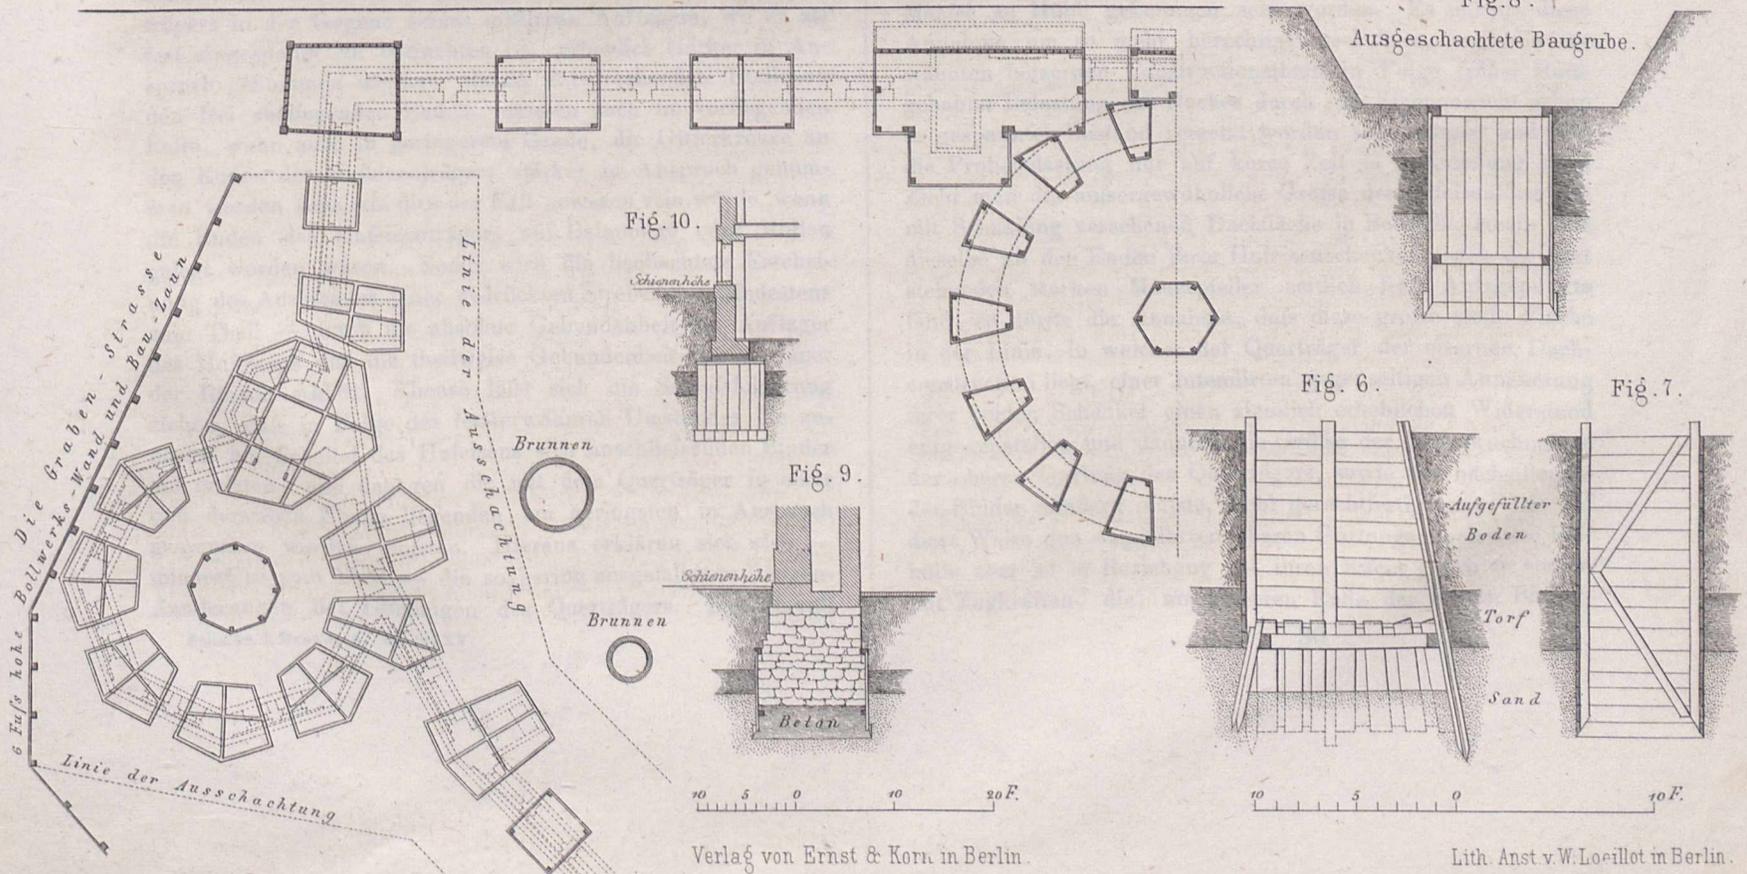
Grundriss, betreffend die Fundirung.
